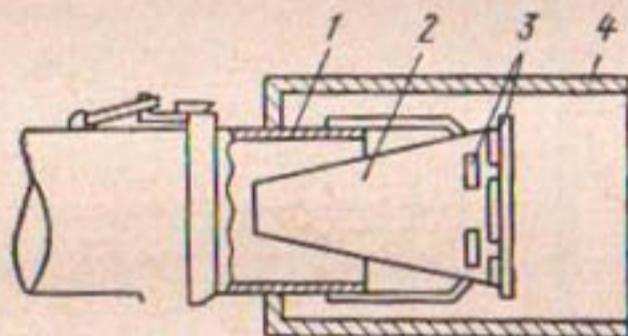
Насадка-гаситель-водовыпуск НГ-1 конструкции ЮжНИИГиМ на концевом участке напорного трубопровода:
